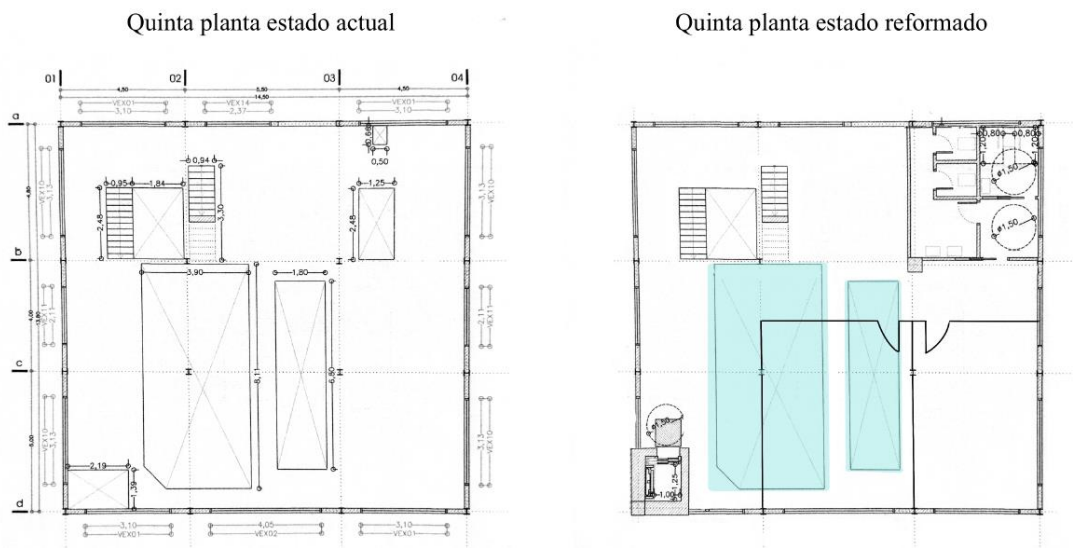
Plano actual y reformado de la quinta planta del Lavadero de carbón del Pozo Casares en Tremor de Arriba. Fuente: plano del estado actual: Francisco De Borja Menéndez y Paula Núñez Álvarez, «Proyecto de rehabilitación del Lavadero Casares para Centro temático de la miel en Tremor de Arriba», 2024, Archivo del Ayuntamiento de Iguëña; plano estado reformado: reelaboración propia.
